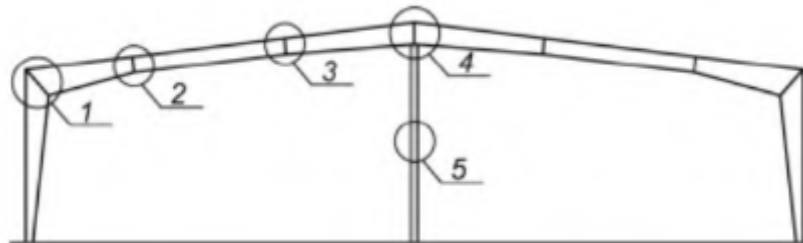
Фланцевые соединения рамных конструкций: 1 — сопряжение крайних стоек с ригелями; 2, 3 — сопряжение элементов ригеля в пролете; 4 — опирание ригеля на средние колонны; 5 — стыки колонн
